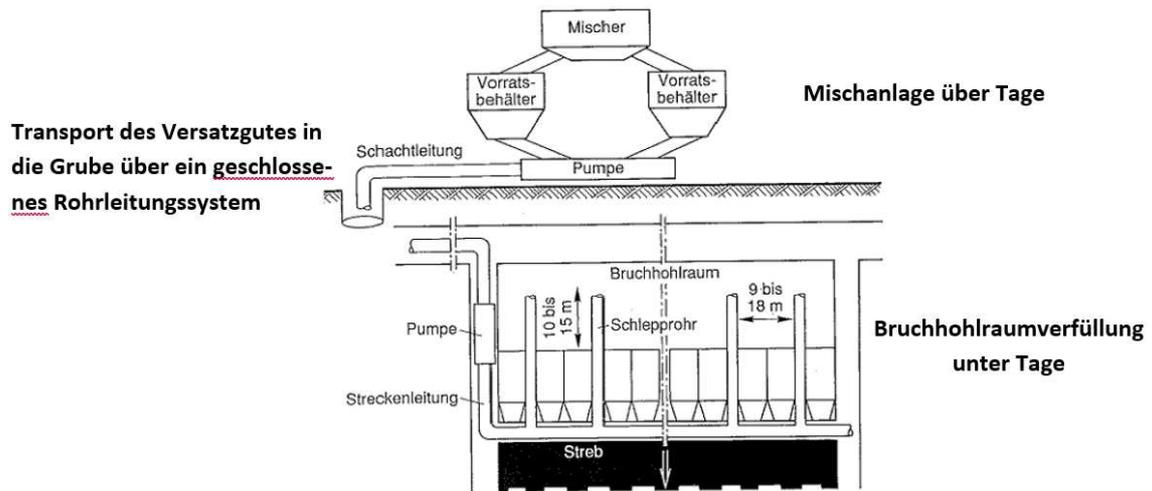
Bruchhohlraumverfüllung – Einbringen pastöser Massen mit Schlepprohren (Plate 1988, ergänzt)
